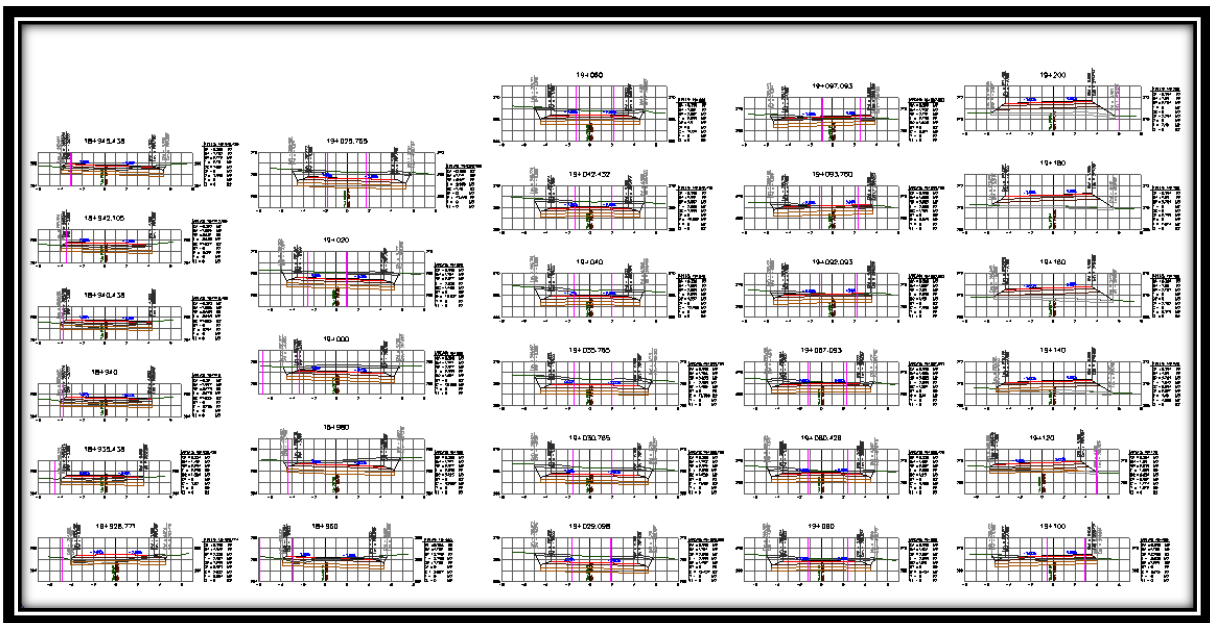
Secciones de construcción del km 18+928.771 al km 19+200.000.
